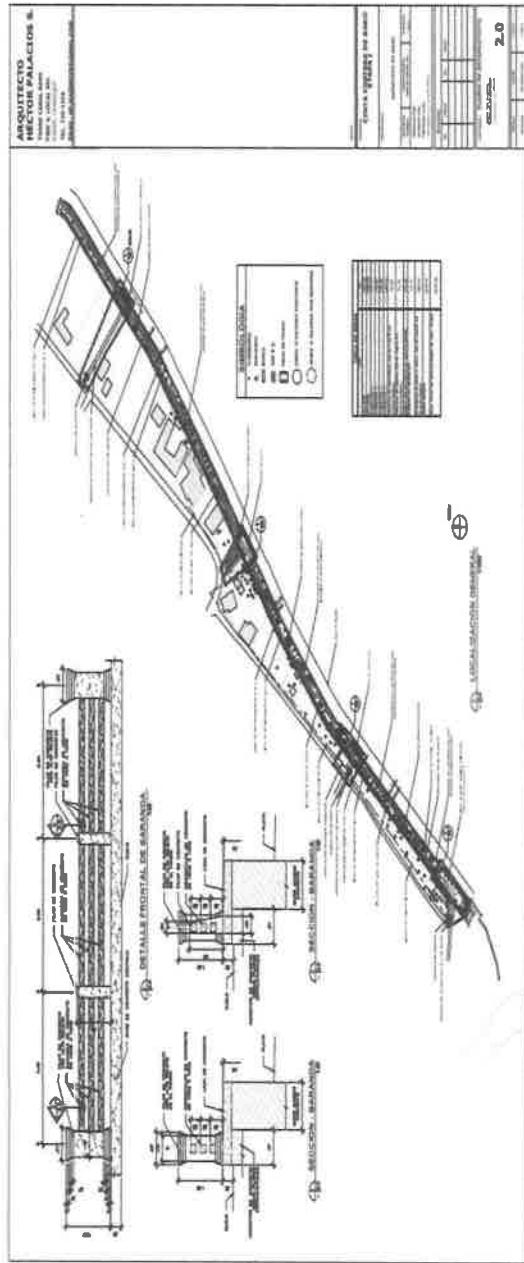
Croquis de infraestructuras futuras de la Cinta Costera de Barú. MUNICIPIO DE BARÚ
